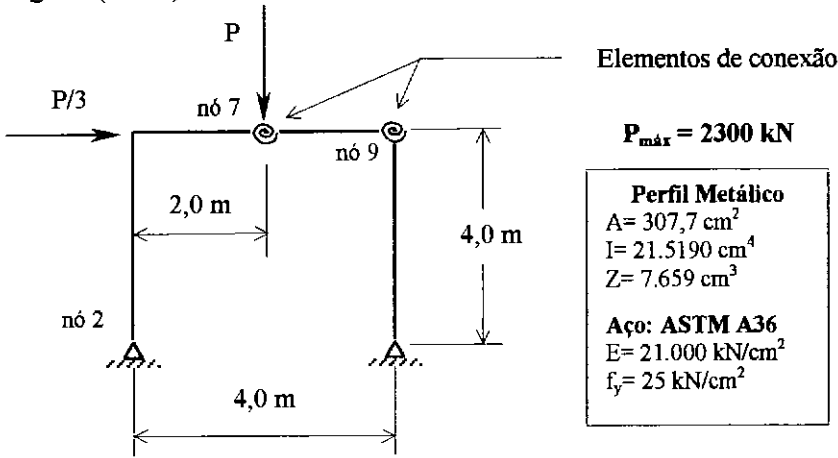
18: Terceiro teste proposto, pórtico plano retangular bi-apoiado.
